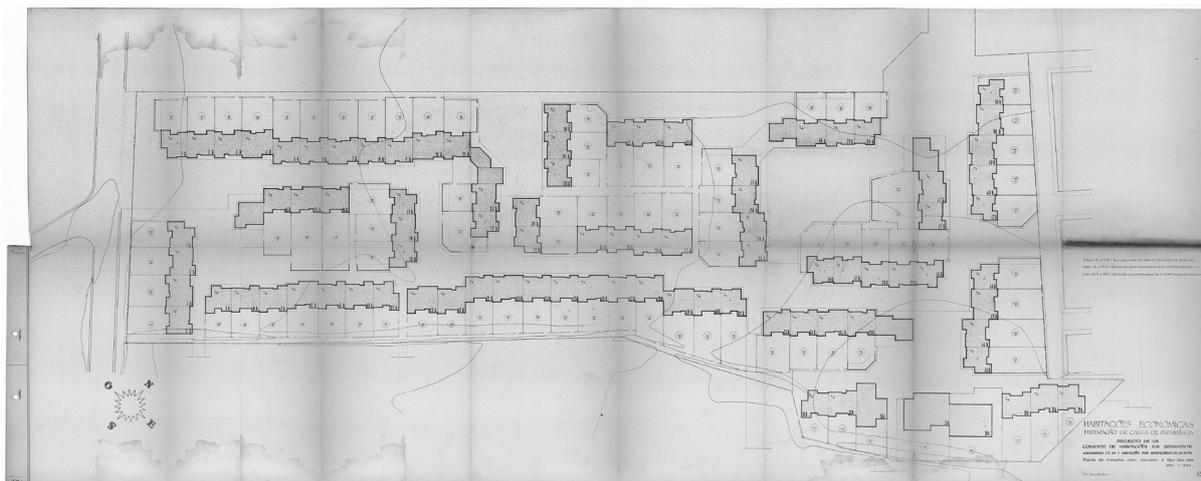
Projeto [1ª versão]: planta de trabalho com o número e tipo de lotes
